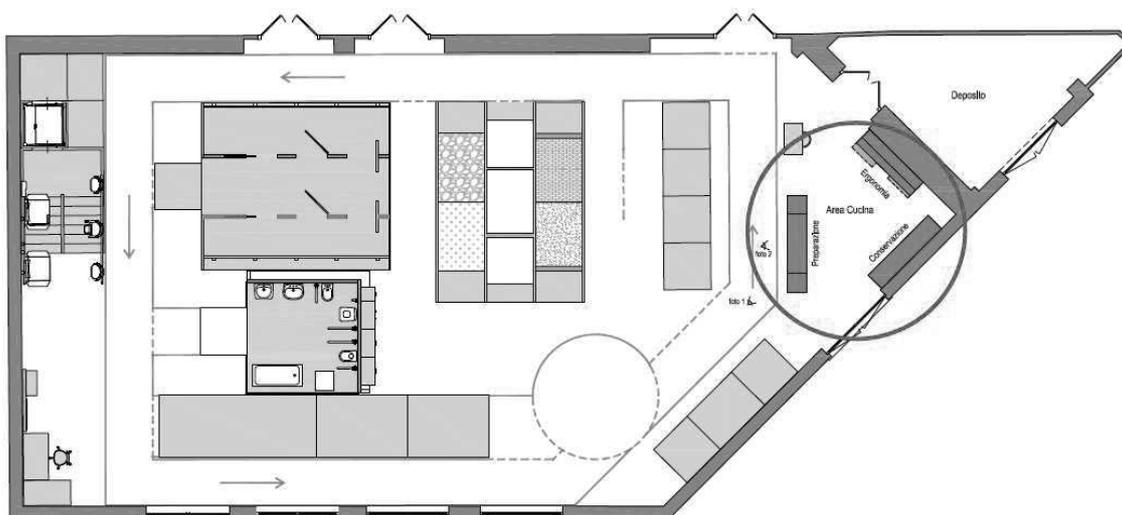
Planimetria Palestra AUSILIA - Area Cucina
